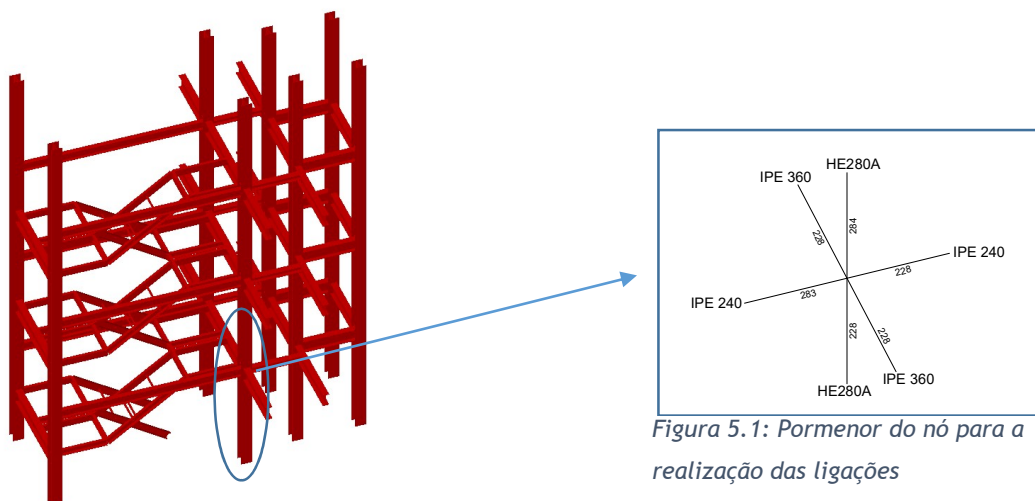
Estrutura metálica, com a representação do nó da ligação a executar as ligações
